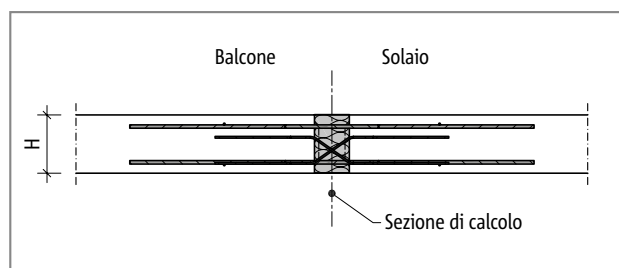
Schöck Isokorb® tipo DXT: sistema statico
